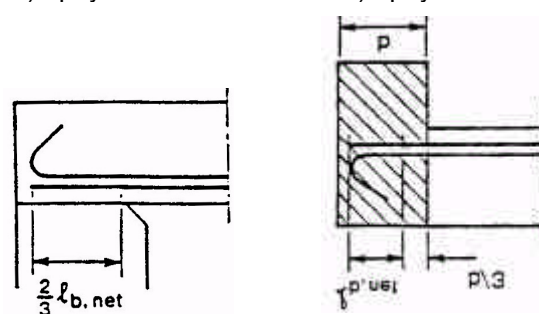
Anclaje de la armadura inferior en apoyos extremos
